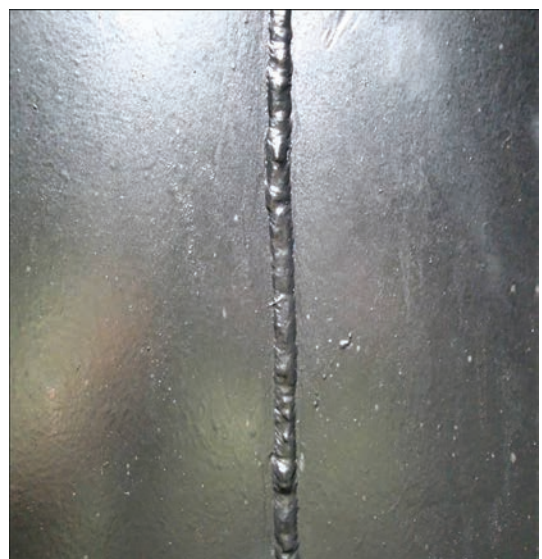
Общий вид вертикальных сварных швов на внутренней поверхности стенки основного резервуара
